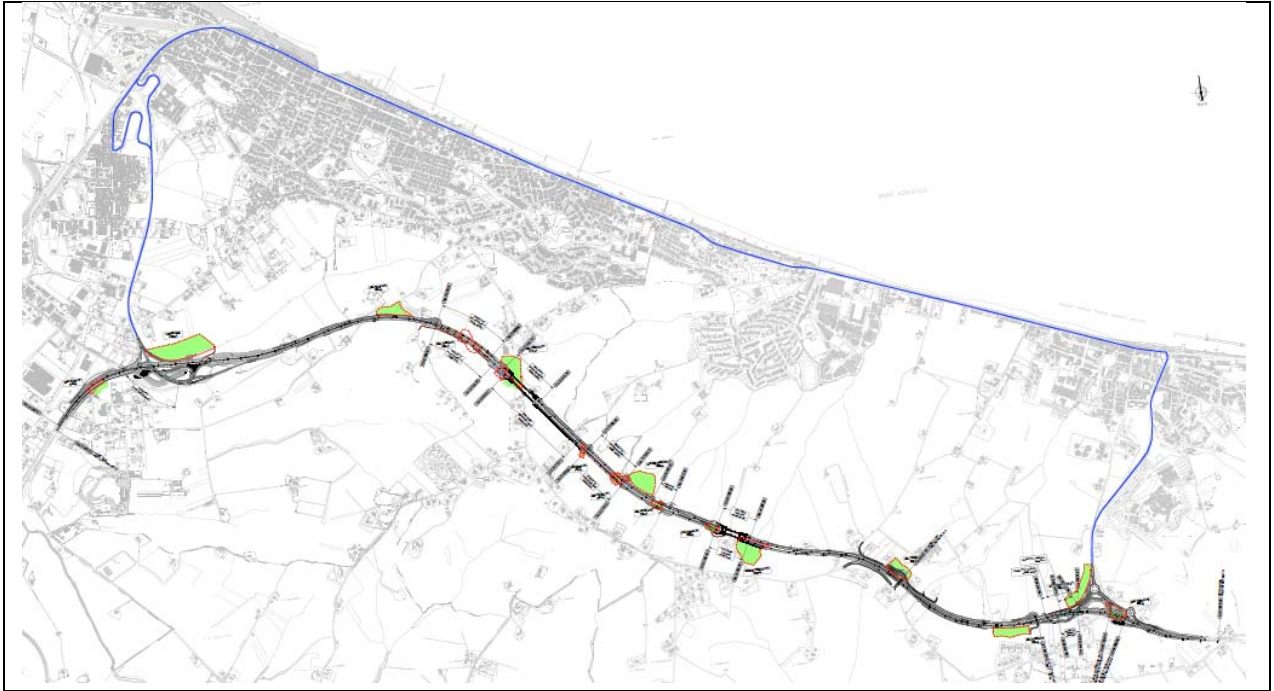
Sovrapposto aree e piste di cantiere PD-PE
